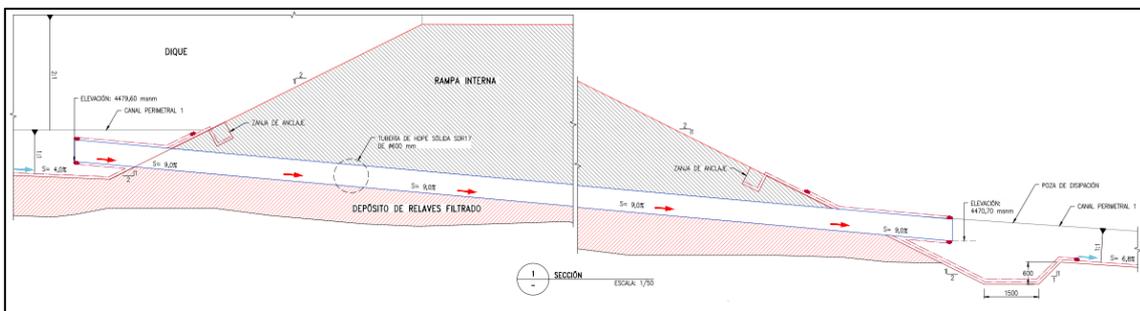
Vista en planta de la configuración de las alcantarillas, tubería y poza de disipación
